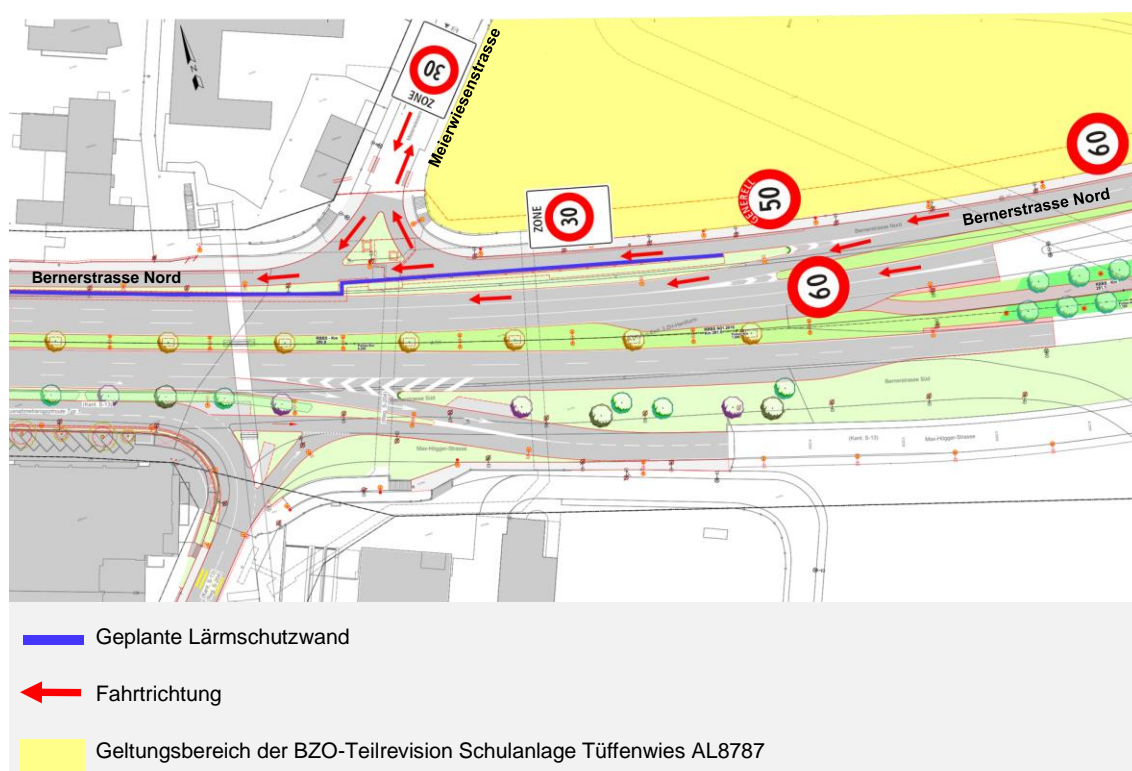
Projekt Anschluss Europabrücke, Detailausschnitt mit Temporegime, basierend auf ASTRA-Projekt, Darstellung TAZ
